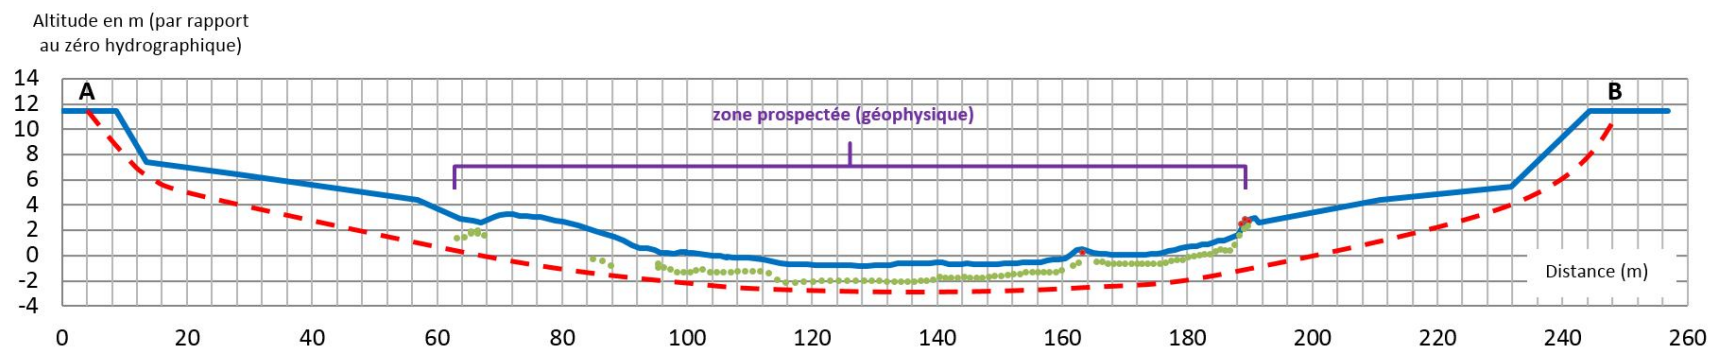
Coupe de principe du forage (ACRI, BIOTOPE)
